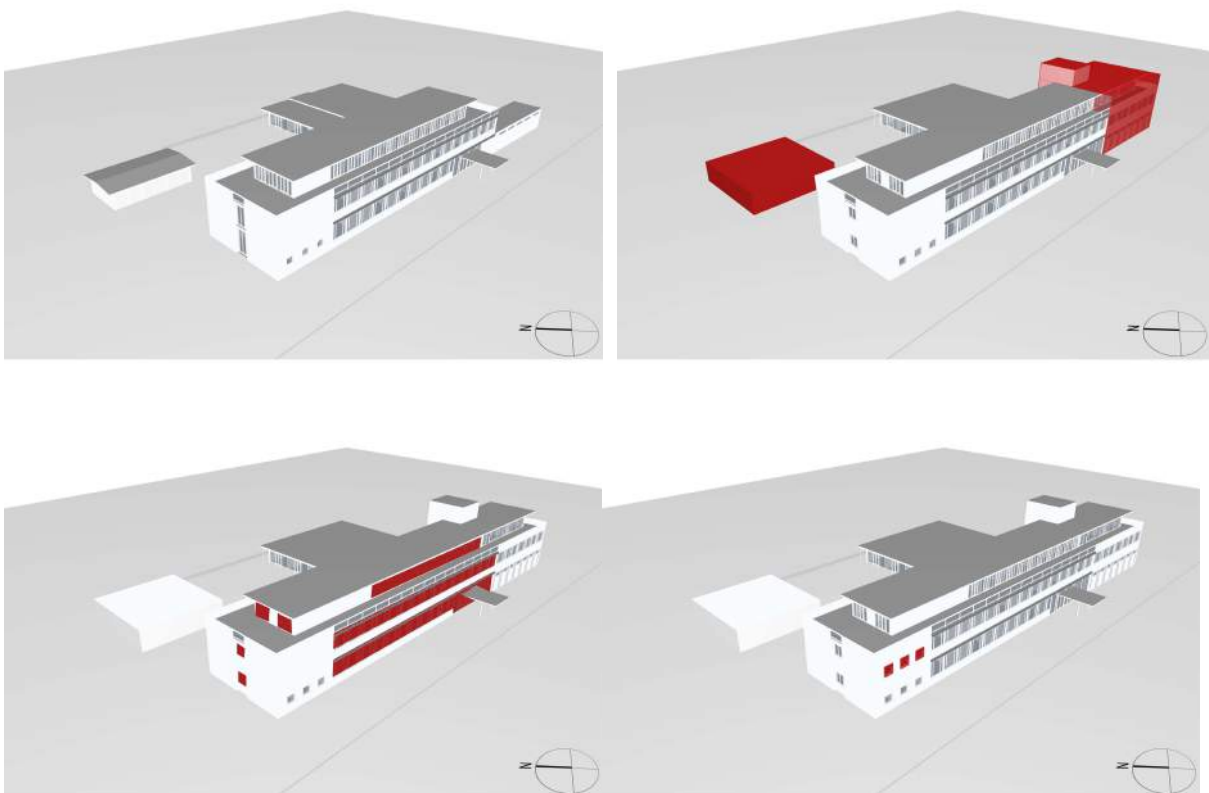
Umbau- und Erweiterungsphasen. Von links oben nach rechts unten: Ursprungsbau 1955 (Hauptbau, Gartenpavillon, Garderobentrakt), Anbau an den Hauptbau und Neubau Hausmeisterwohnung anstelle der Garage 1983, Austausch der bauzeitlichen Fassaden 1992, heutiger Zustand mit drei neuen Fenstern von 2010.
